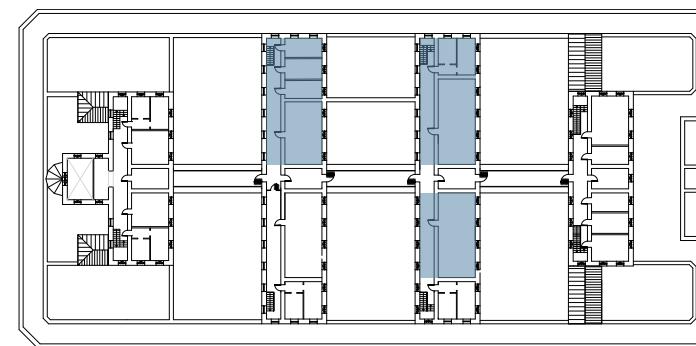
Plans de Rdc et R+1 : plan d'origine, hypothèse. Mise en valeur des espaces où le plan d'origine n'a pas pu être restitué. Source : Croisée d'archi.
